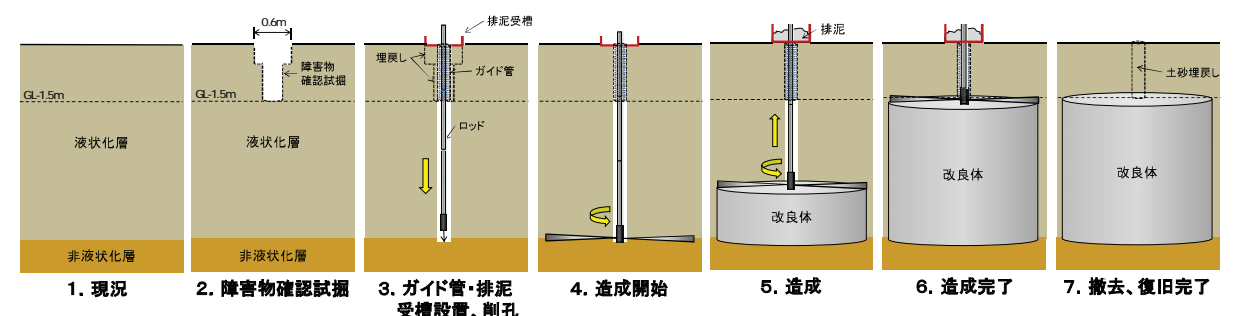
高圧噴射攪拌工法の施工手順 (宅地部を標準)
